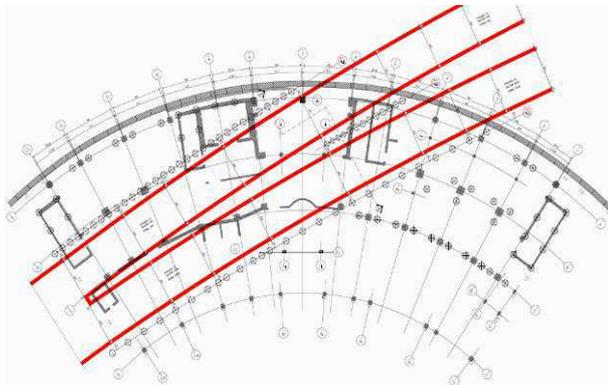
Sovrapposizione Torre C – Passante Ferroviario; sezione sulle gallerie ferroviarie
